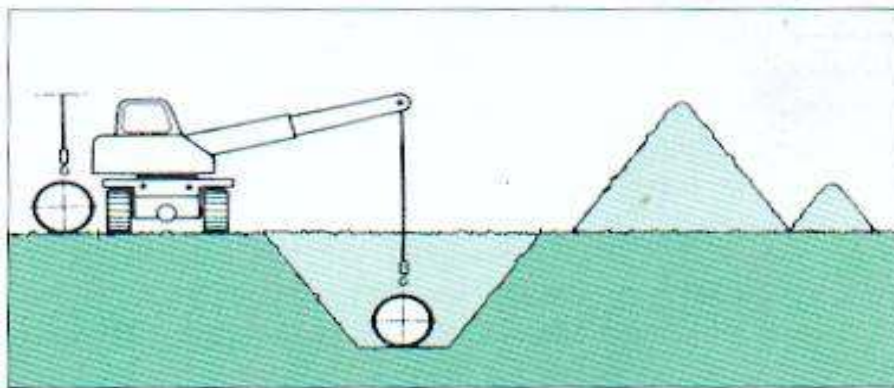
POSE DE LA CONDUITE EN TRANCHEE
